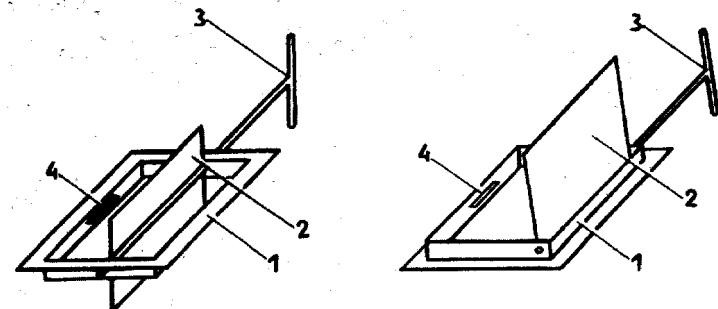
Устройство для перекрытия канала дымовой трубы:
